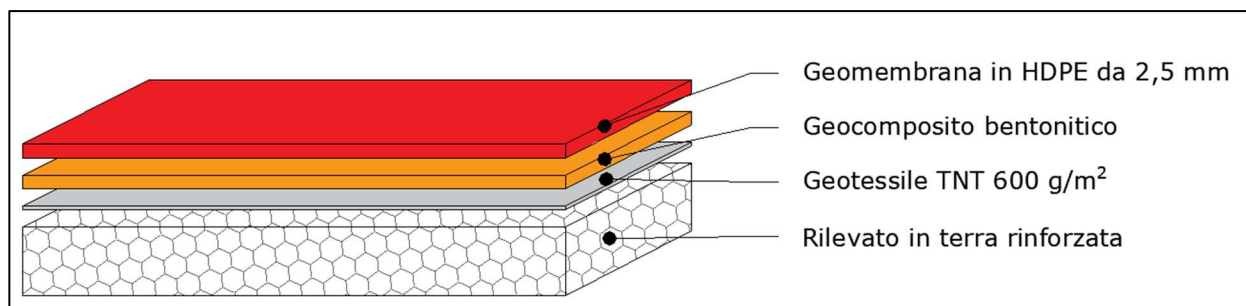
/XIV: Particolare pacchetto impermeabilizzazione versante in roccia
